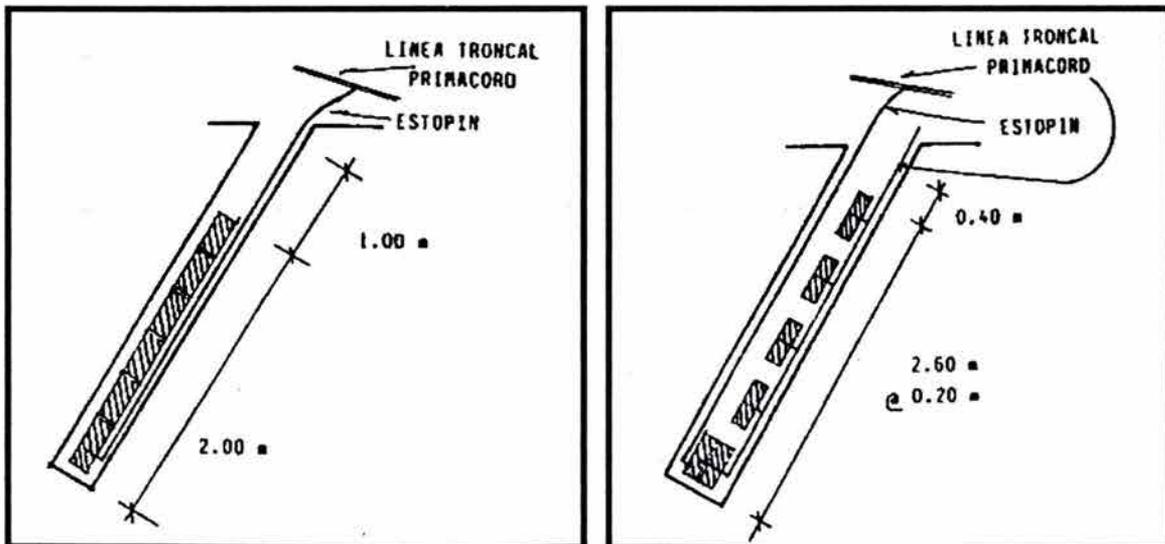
ANÁLISIS PARA LA BARRENACIÓN CON TUNNEL-TRACK,
